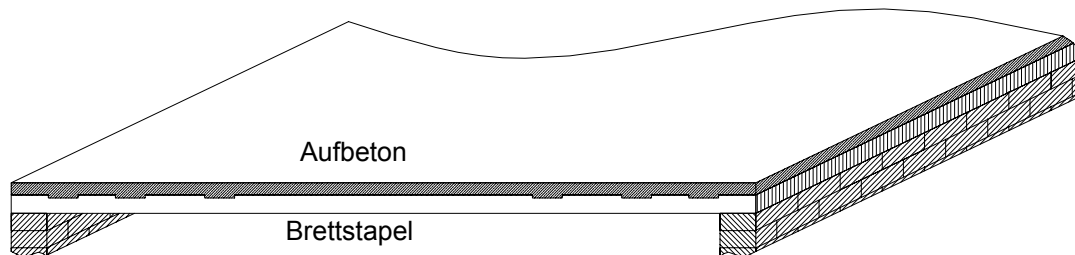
Brettstapel-Beton-Verbunddecke in realer Einbausituation
